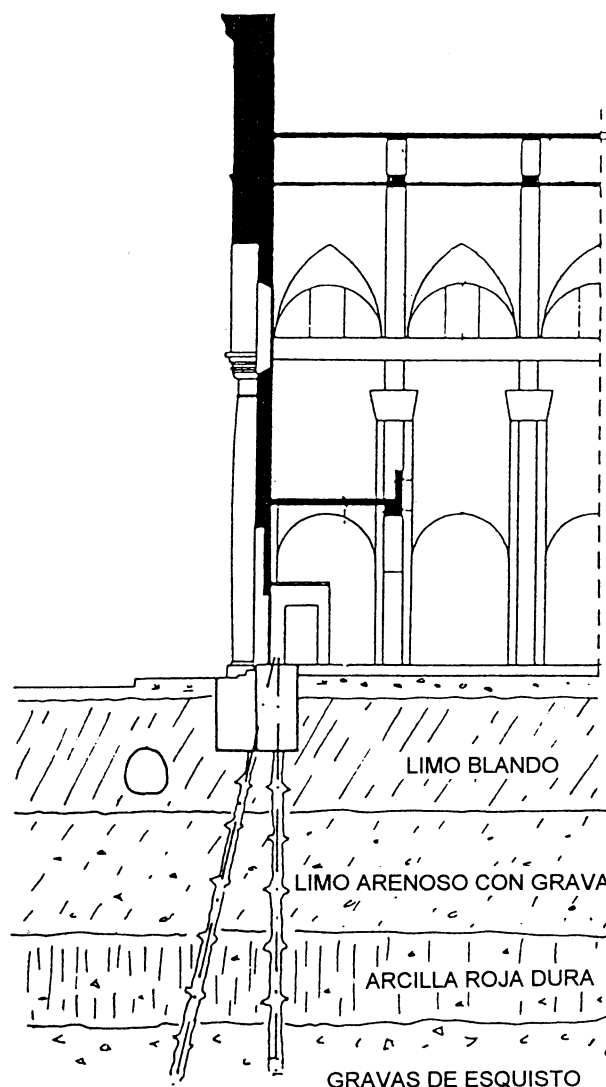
Recalce de la fachada de la iglesia de Sant Andreu del Palomar.
